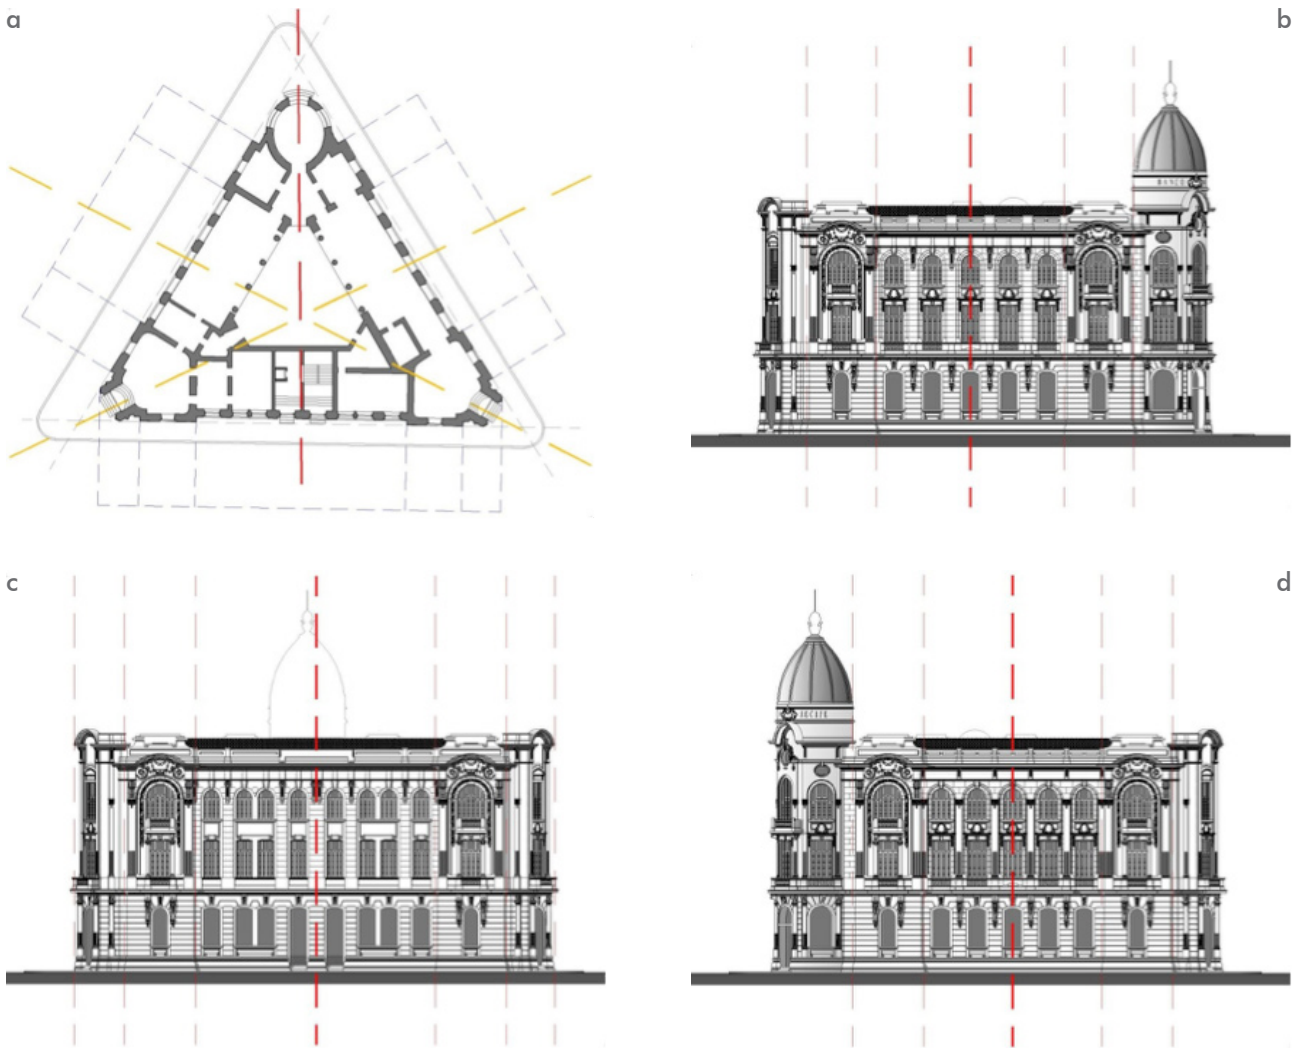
| Planta-baixa do pavimento térreo e fachadas do Banco do Recife. 4a: Planta Baixa do Pavimento Térreo; 4b: Fachada da Rua do Bom Jesus; 4c: Fachada da Rua Dona Maria César; 4d: Fachada da Avenida Rio Branco
